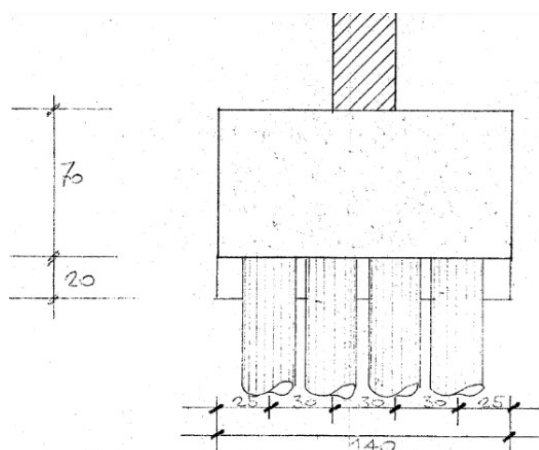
Schema tipico della fondazione in corrispondenza del perimetro indagato
